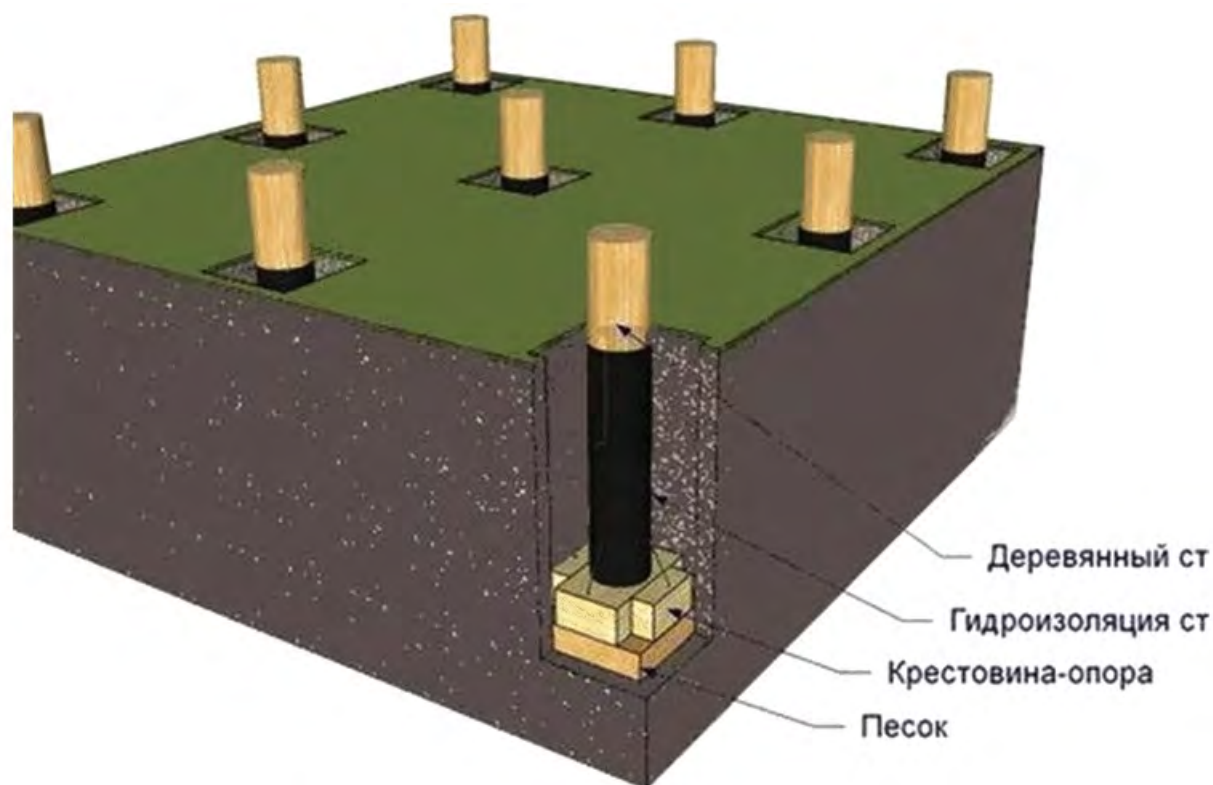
Деревянные столбы перед установкой обязательно надо покрыть слоем гидроизоляции
